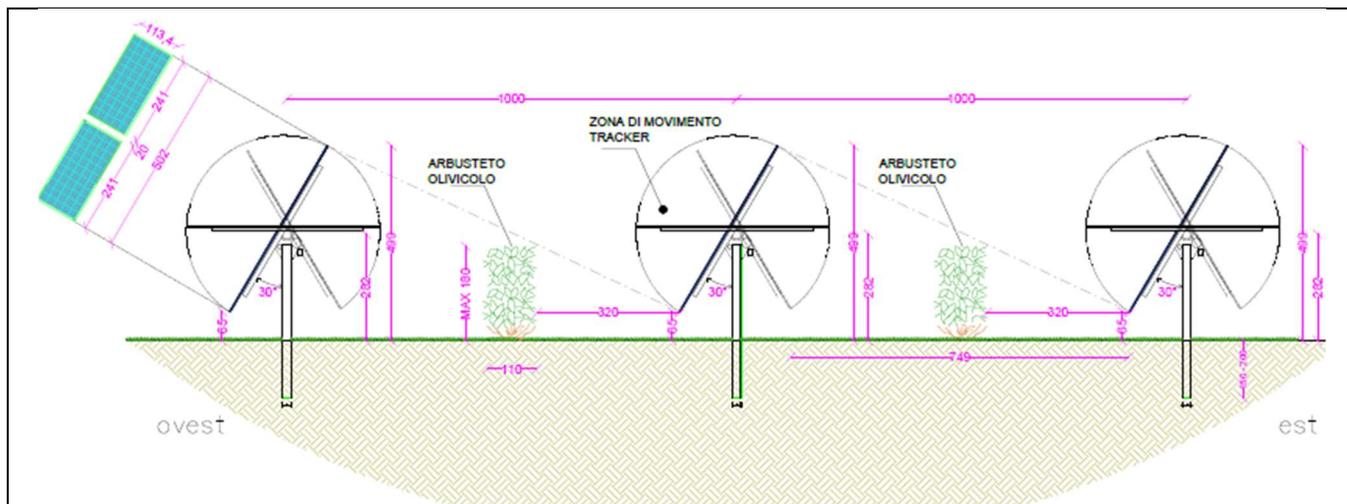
Sezione tipo impianto con installazione su sistema ad inseguimento solare tipo tracker
